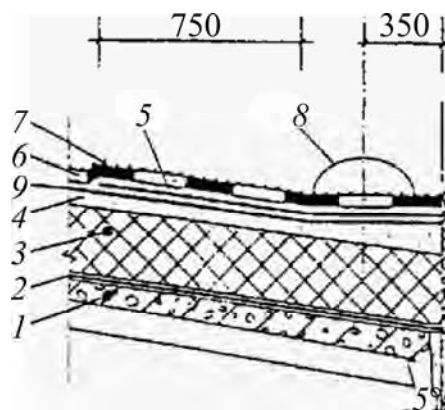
Ендова традиционного покрытия: 1 — железобетонная плита покрытия; 2 — пароизоляция; 3 — теплоизоляция; 4 — цементно-песчаная стяжка; 5 — основной кровельный ковер; 6 — крупнозернистая посыпка верхнего слоя материала; 7 — дополнительный слой кровельного материала; 8 — точечная приклейка теплоизоляции; 9 — грунтовка
